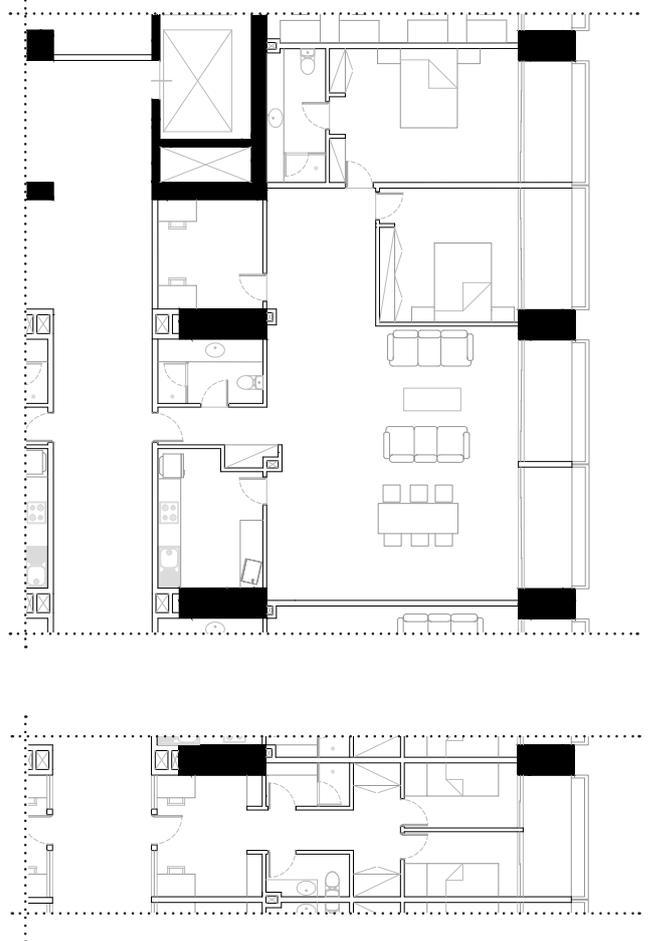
Planta do piso da tipologia com 1 quarto, escala: 1/200
